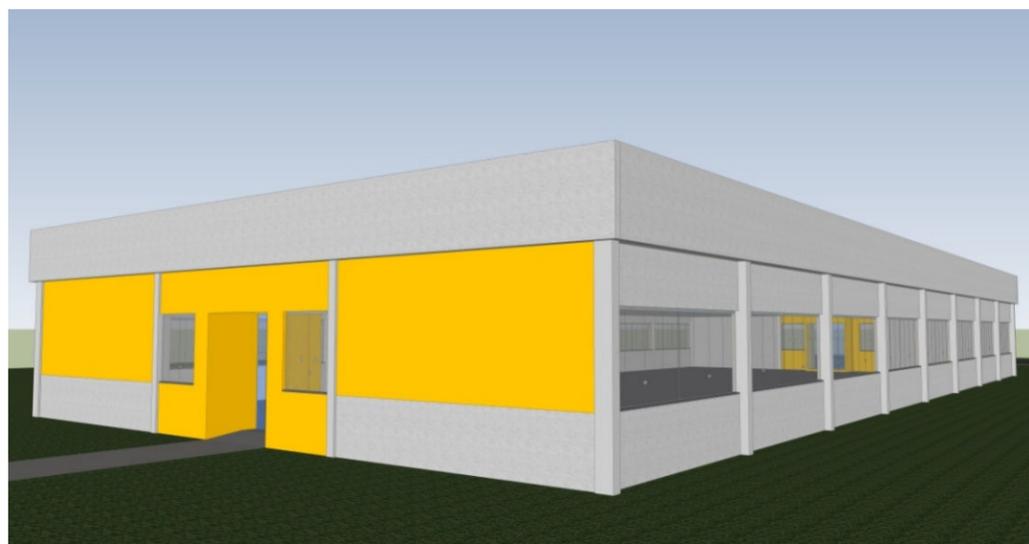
IMAGEM FACHADAS PAVILHÕES - CAMPUS PR & RS
